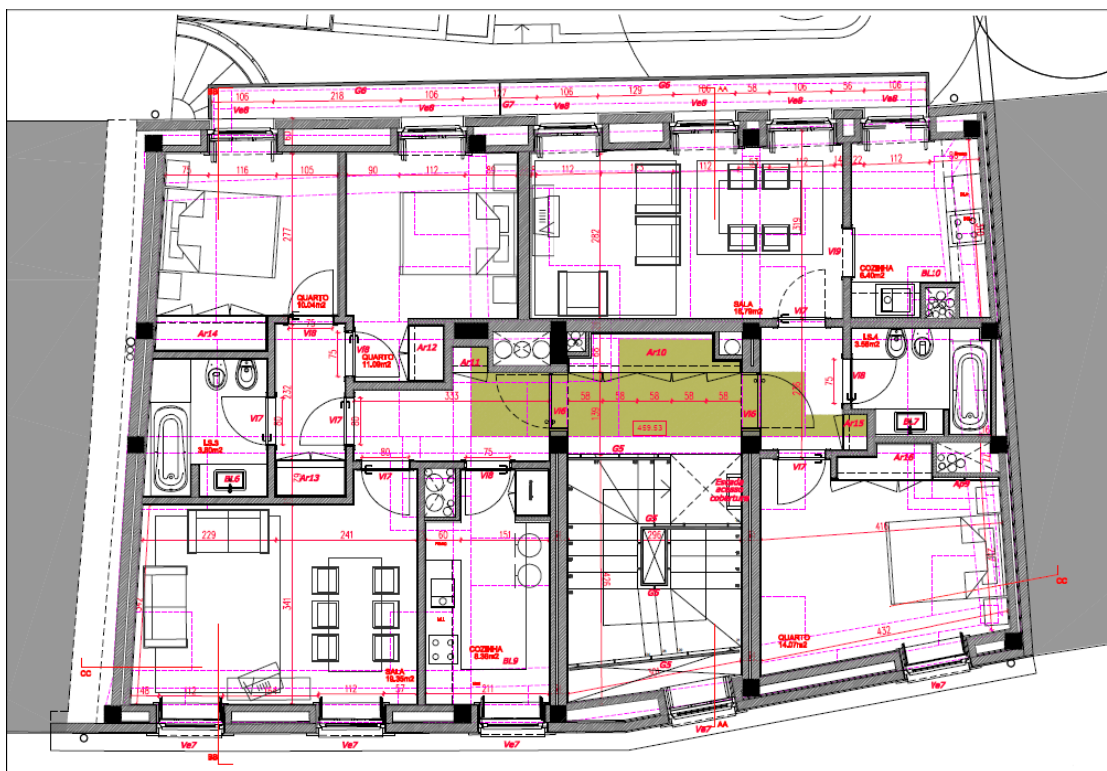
Planta do piso 2 do edifício 4 em estudo, proposta pela arquitetura
